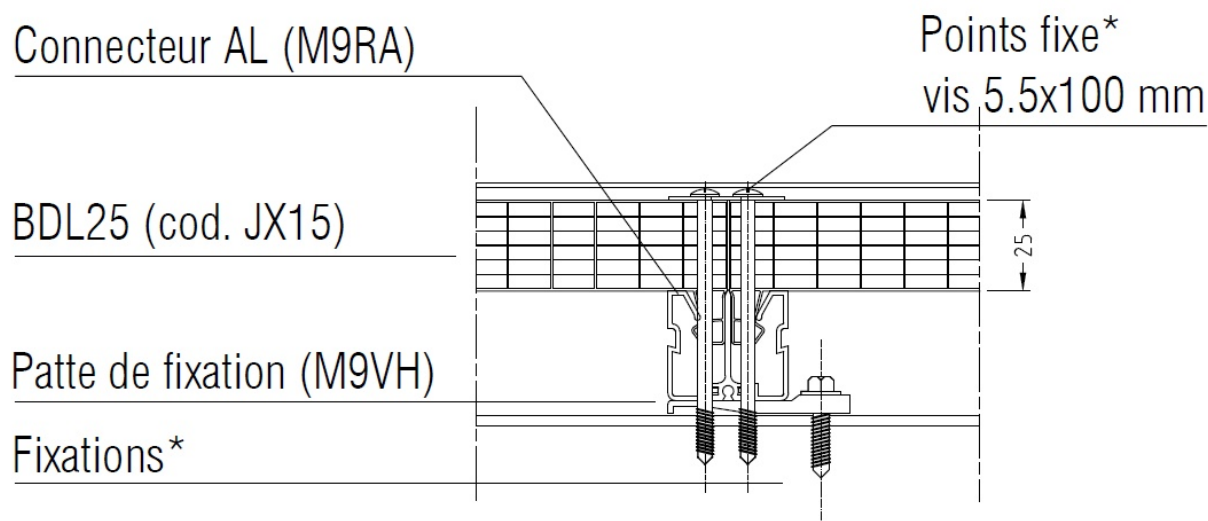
Position en section point fixe - Pose avec point fixe haut
